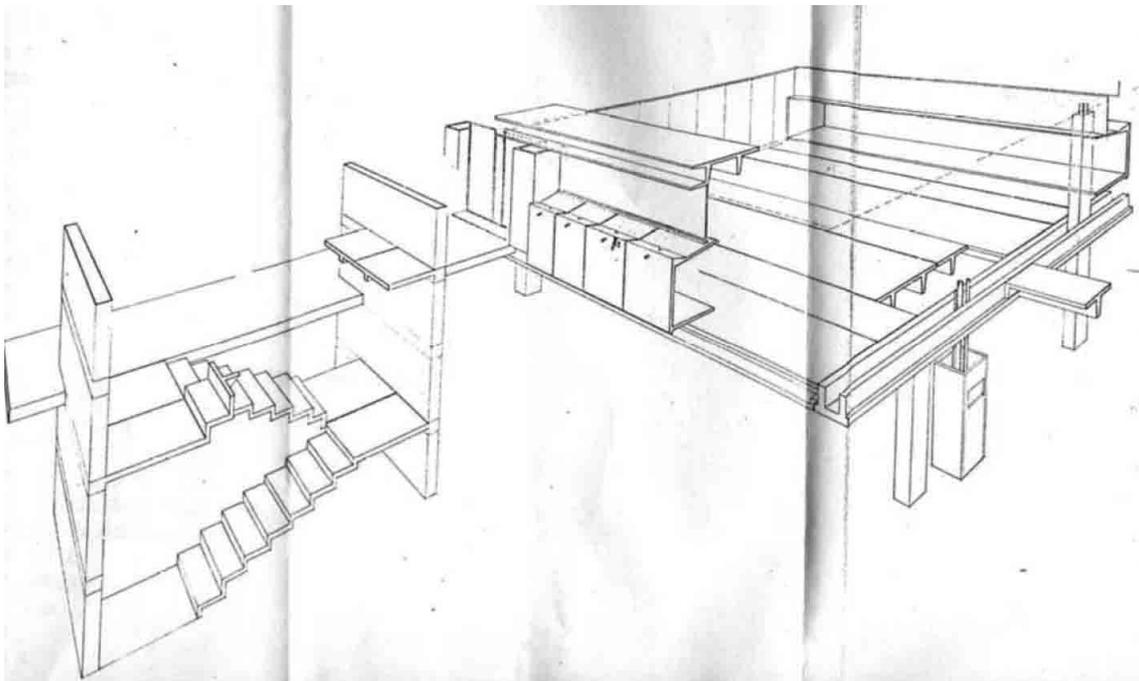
Perspectiva del montaje en prefabricado (Fuente: <sup>15</sup>)
